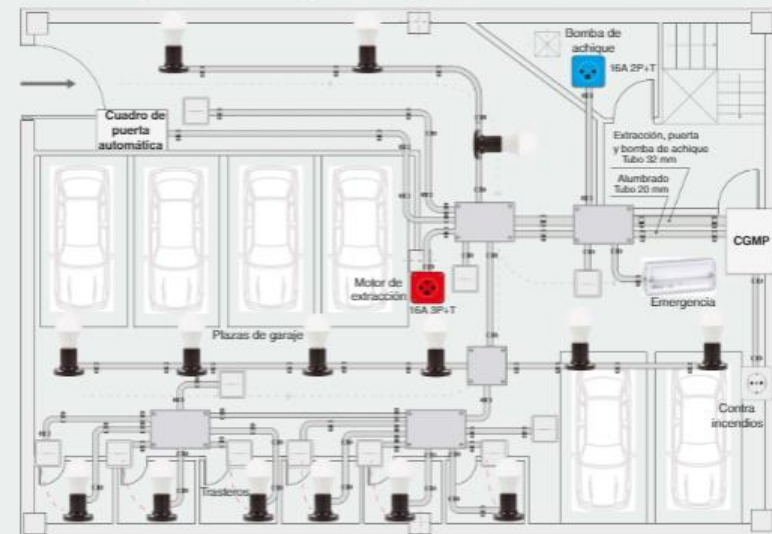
Esquema de montaje de la instalación interior del garaje.
